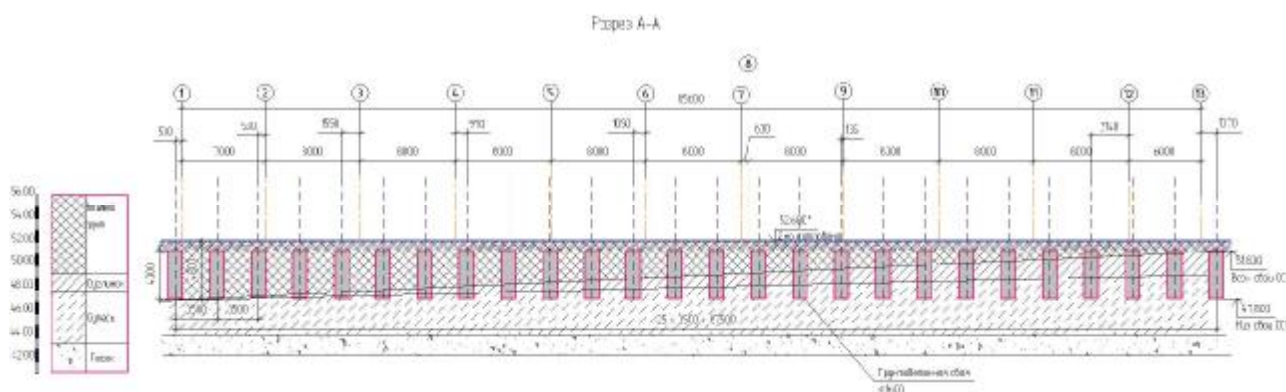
Схема закрепления грунтового основания при строительстве фундаментной плиты.
